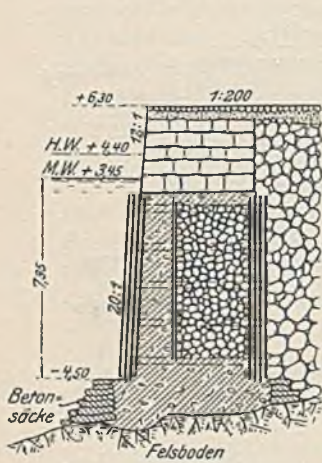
Gründung einer Kaimauer auf einer Steinkiste in Stockholm.
